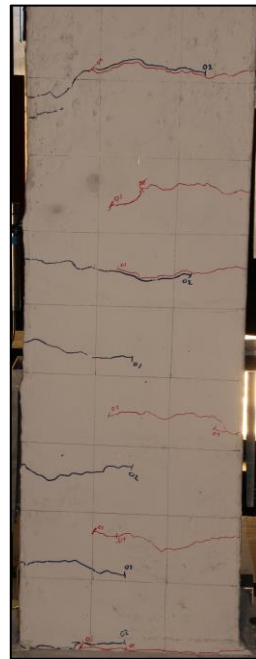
Fissuration horizontale de la colonne C1A au LS2
